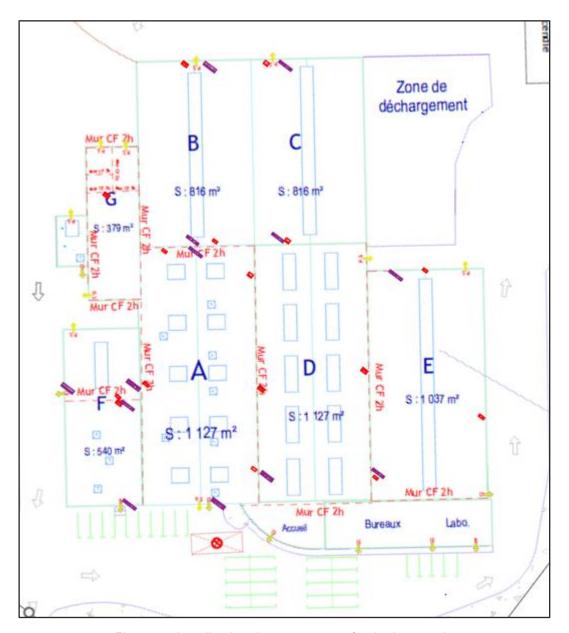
Localisation des murs coupe-feu bâtiment existant
